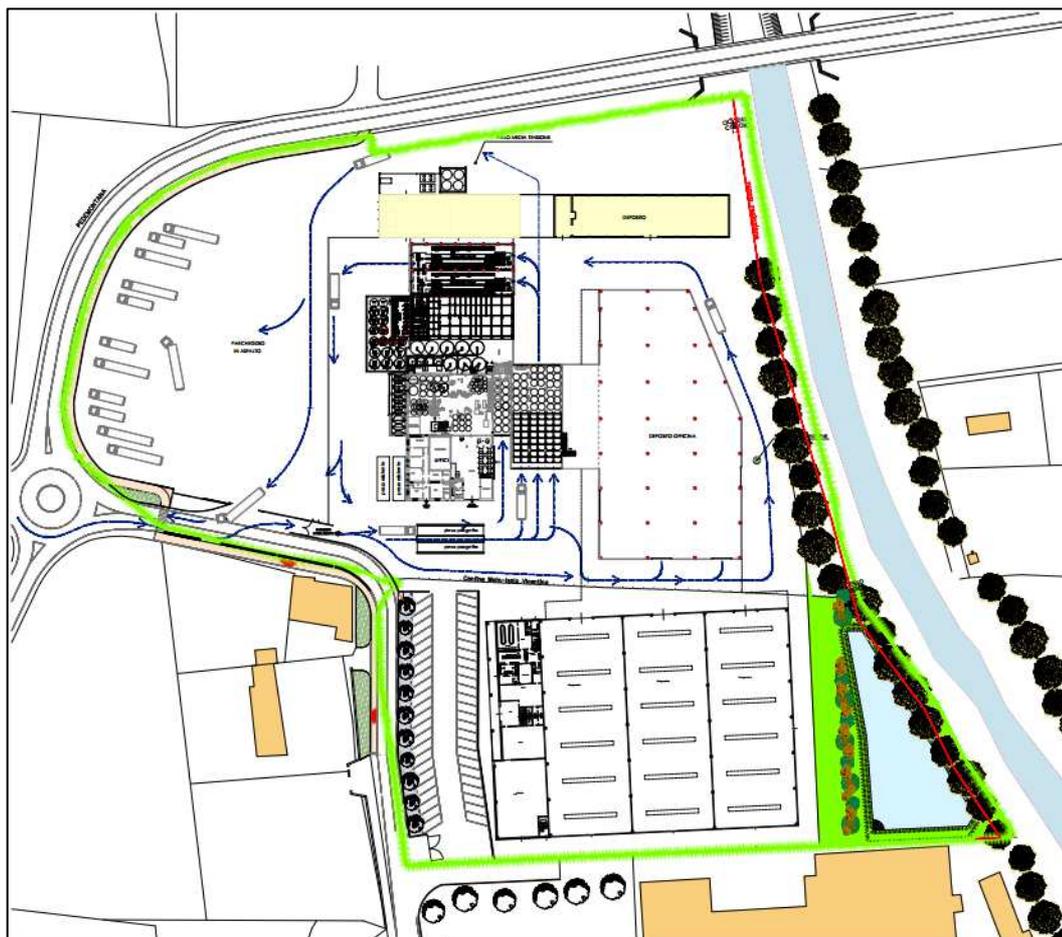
PLANIMETRIE DI PROGETTO
